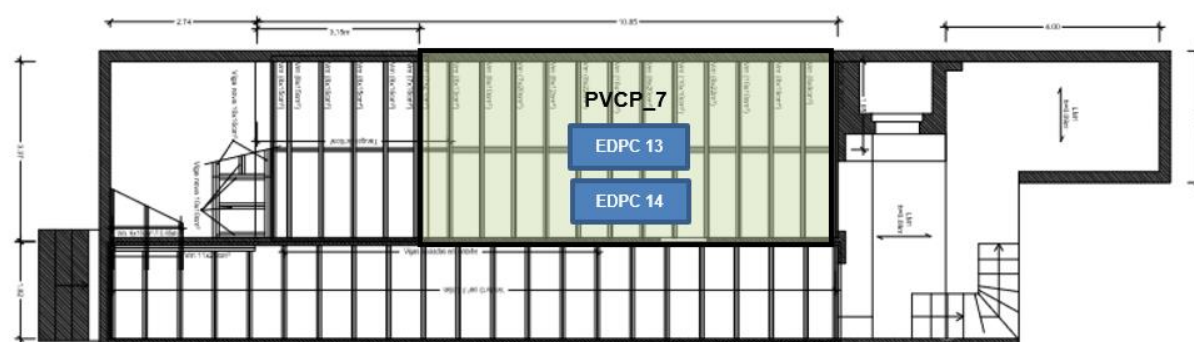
Planta do piso 0, com a identificação esquemática dos pavimentos e ensaios dinâmicos
